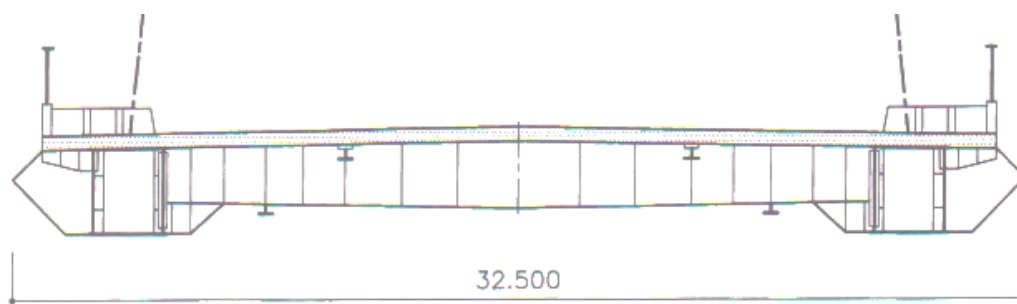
Seção transversal mista - Ponte sobre o Rio Yang Pu, Shanghai, China (GIMSING, 1997)
